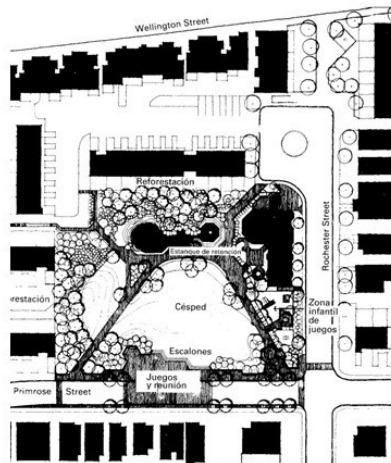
Planimetría de Lebreton Flats, Ottawa.
